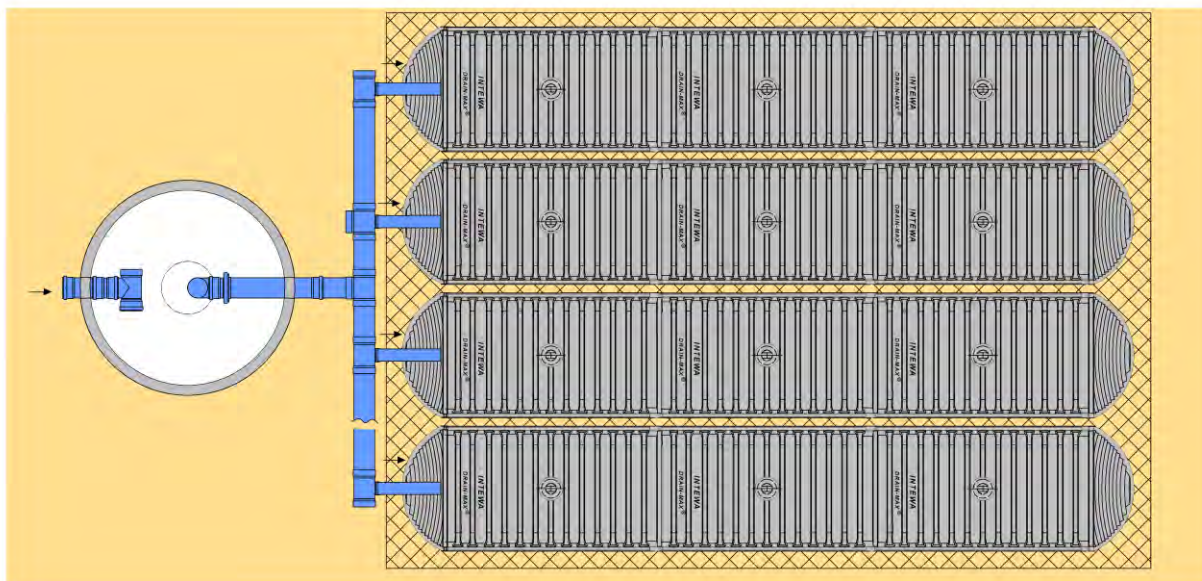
Esempio di sistema di tubazioni collegato al pozzetto di sedimentazione e filtrazione preliminare
